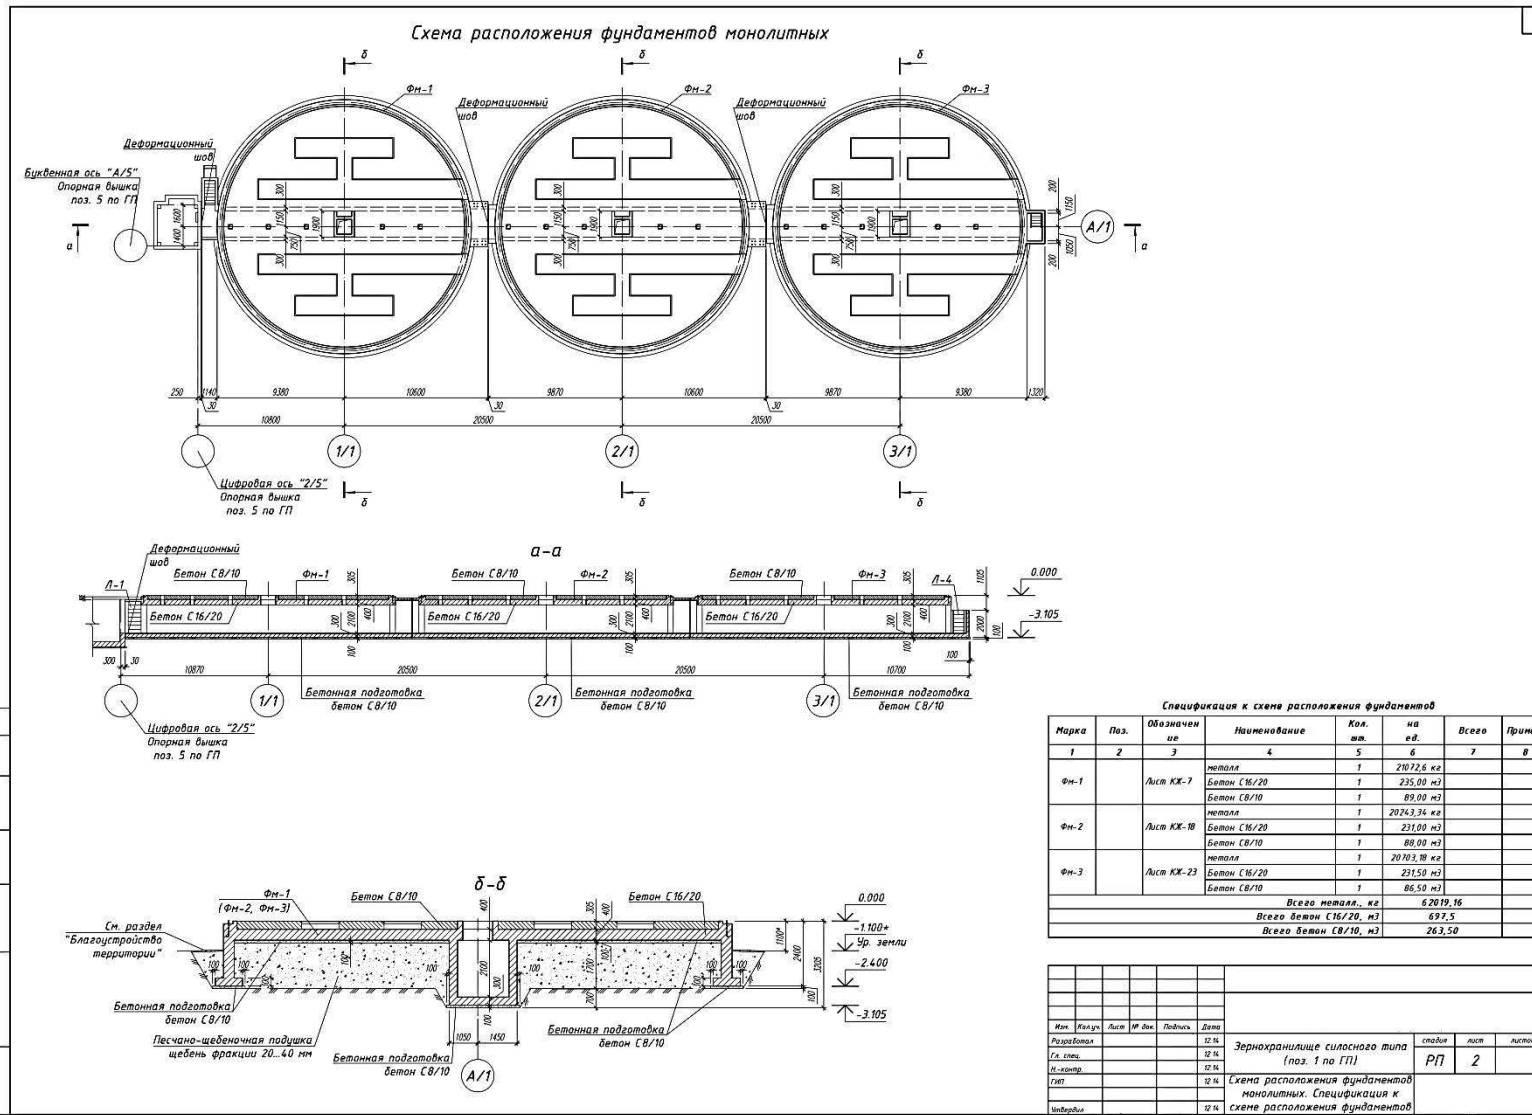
Пример кресления фундамента зернохранилища силосного типа
